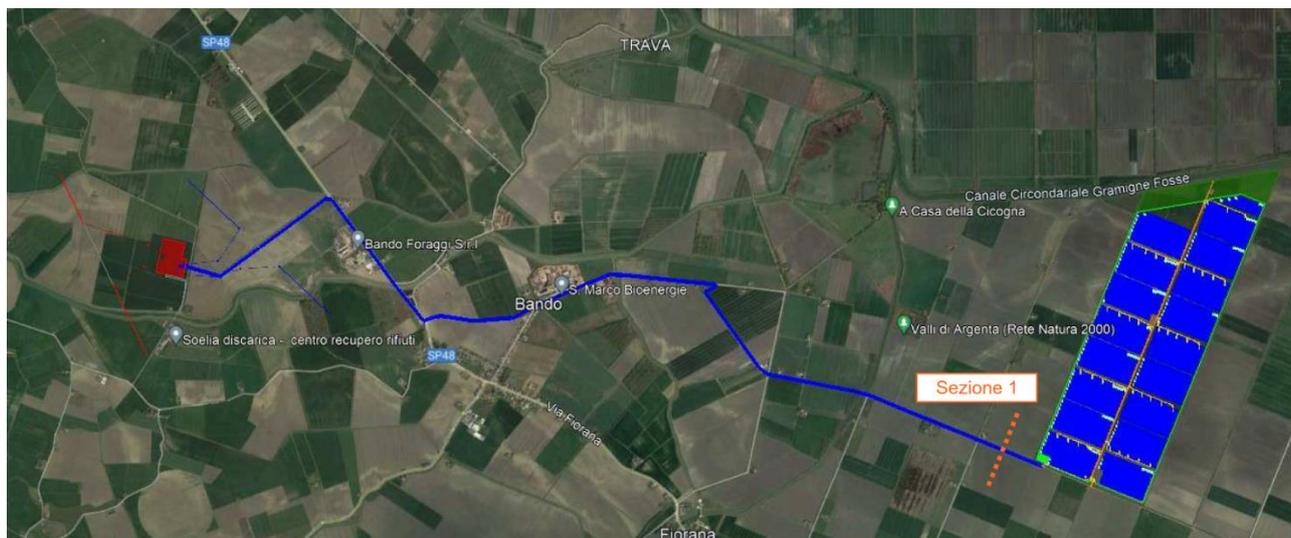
Planimetria con Sezione 1 – Linea cavo in alta tensione
